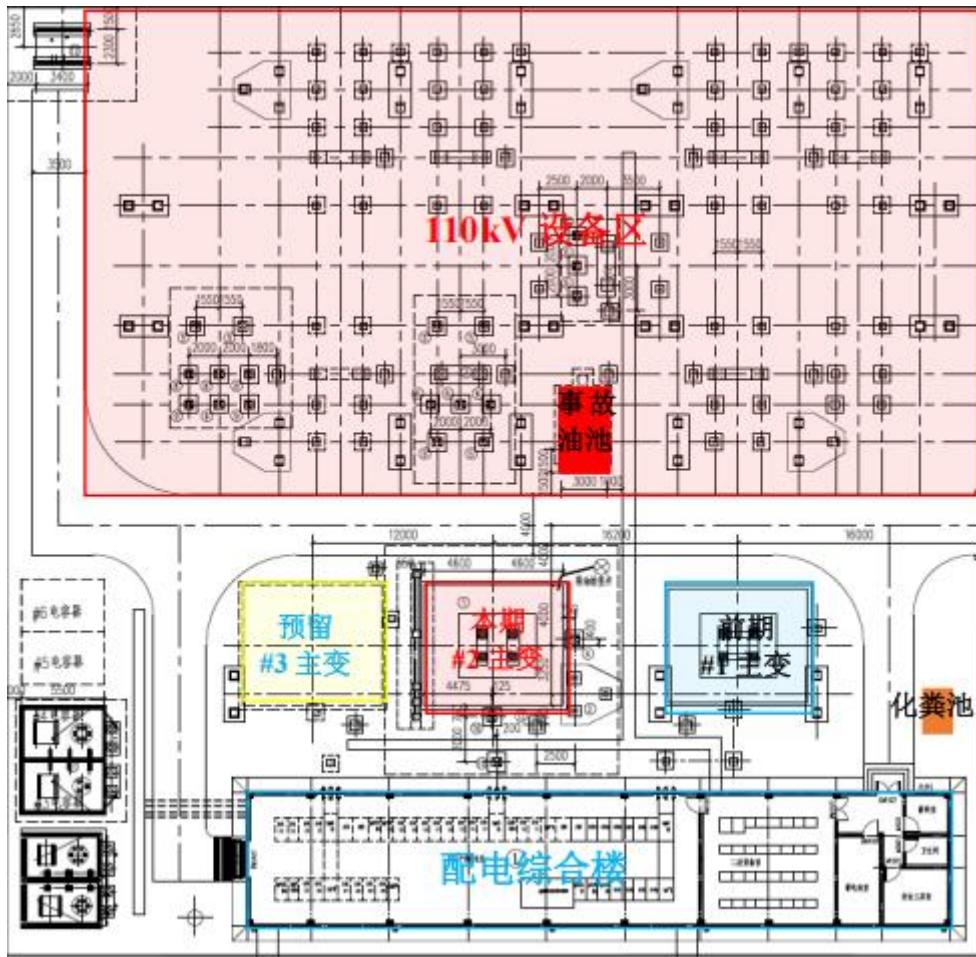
长葛坡湖 110 千伏变电站平面布置示意图
